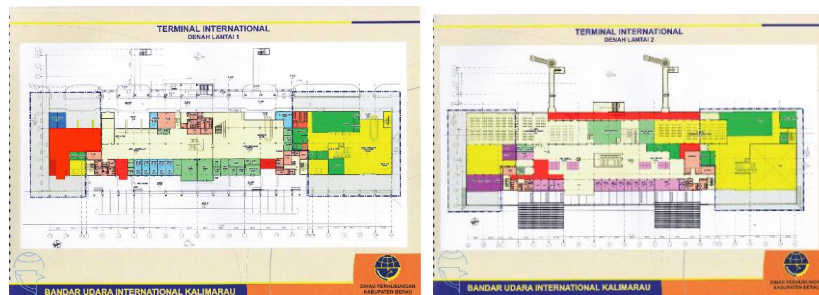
Denah Terminal Bandar Udara Kalimarau Lantai 1 dan Lantai 2
